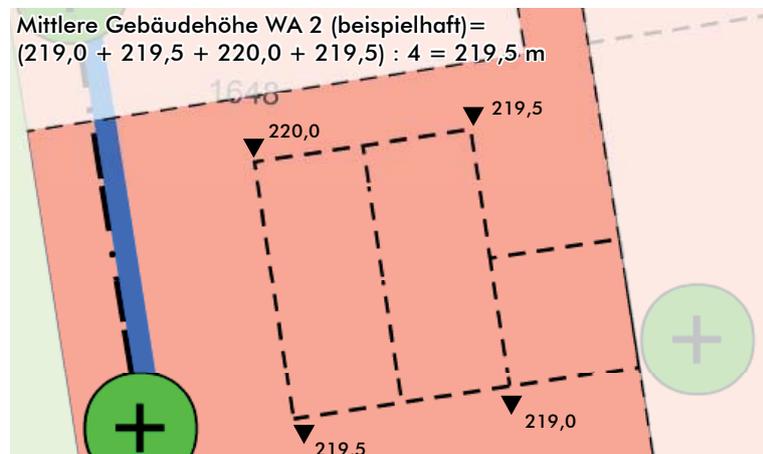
Schemagrundriss Unterer Bezugspunkt WH und GH im WA 2, unmaßstäblich
